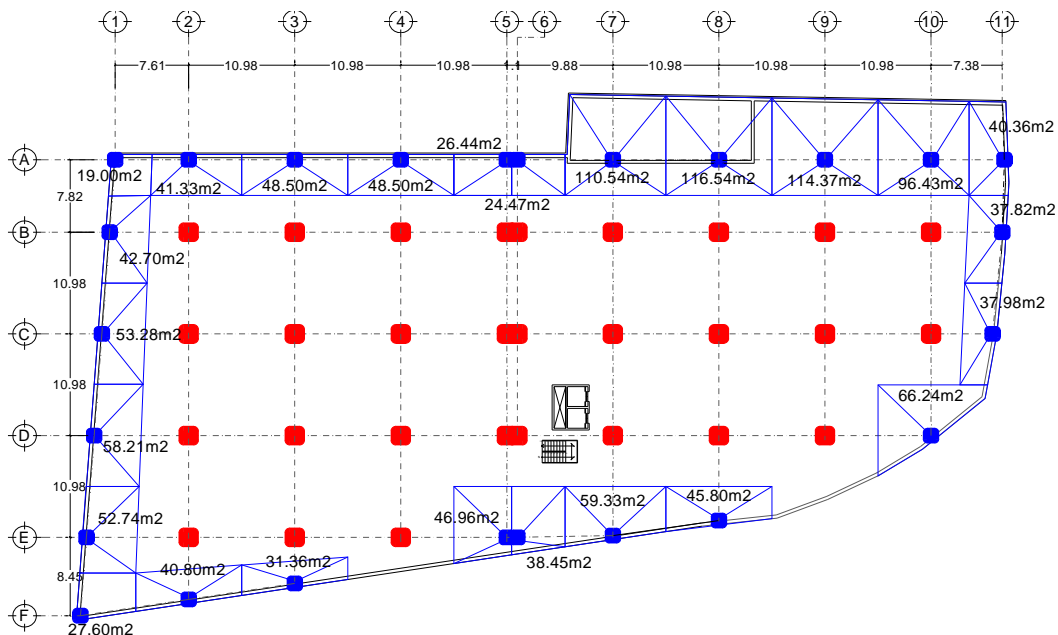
Área tributaria de las columnas del estacionamiento
